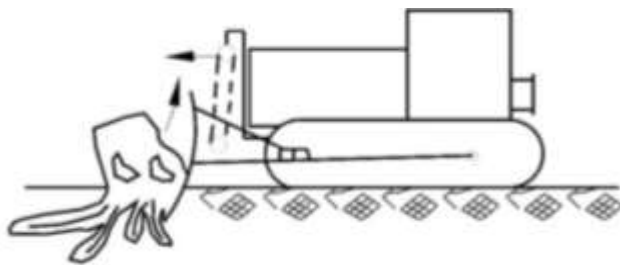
Корчевка пней корчевательной лопатой
